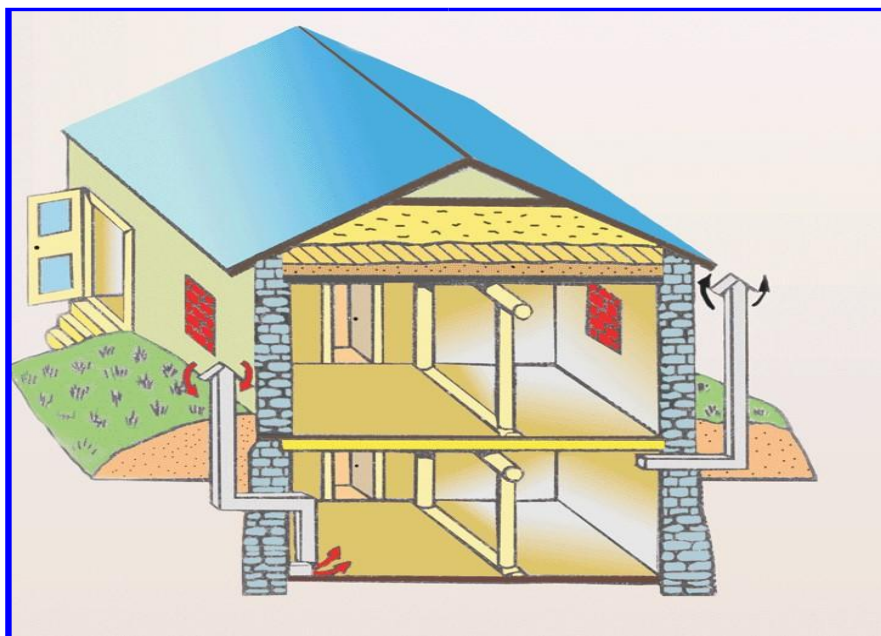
Оборудование подвального помещения под противорадиационное укрытие
